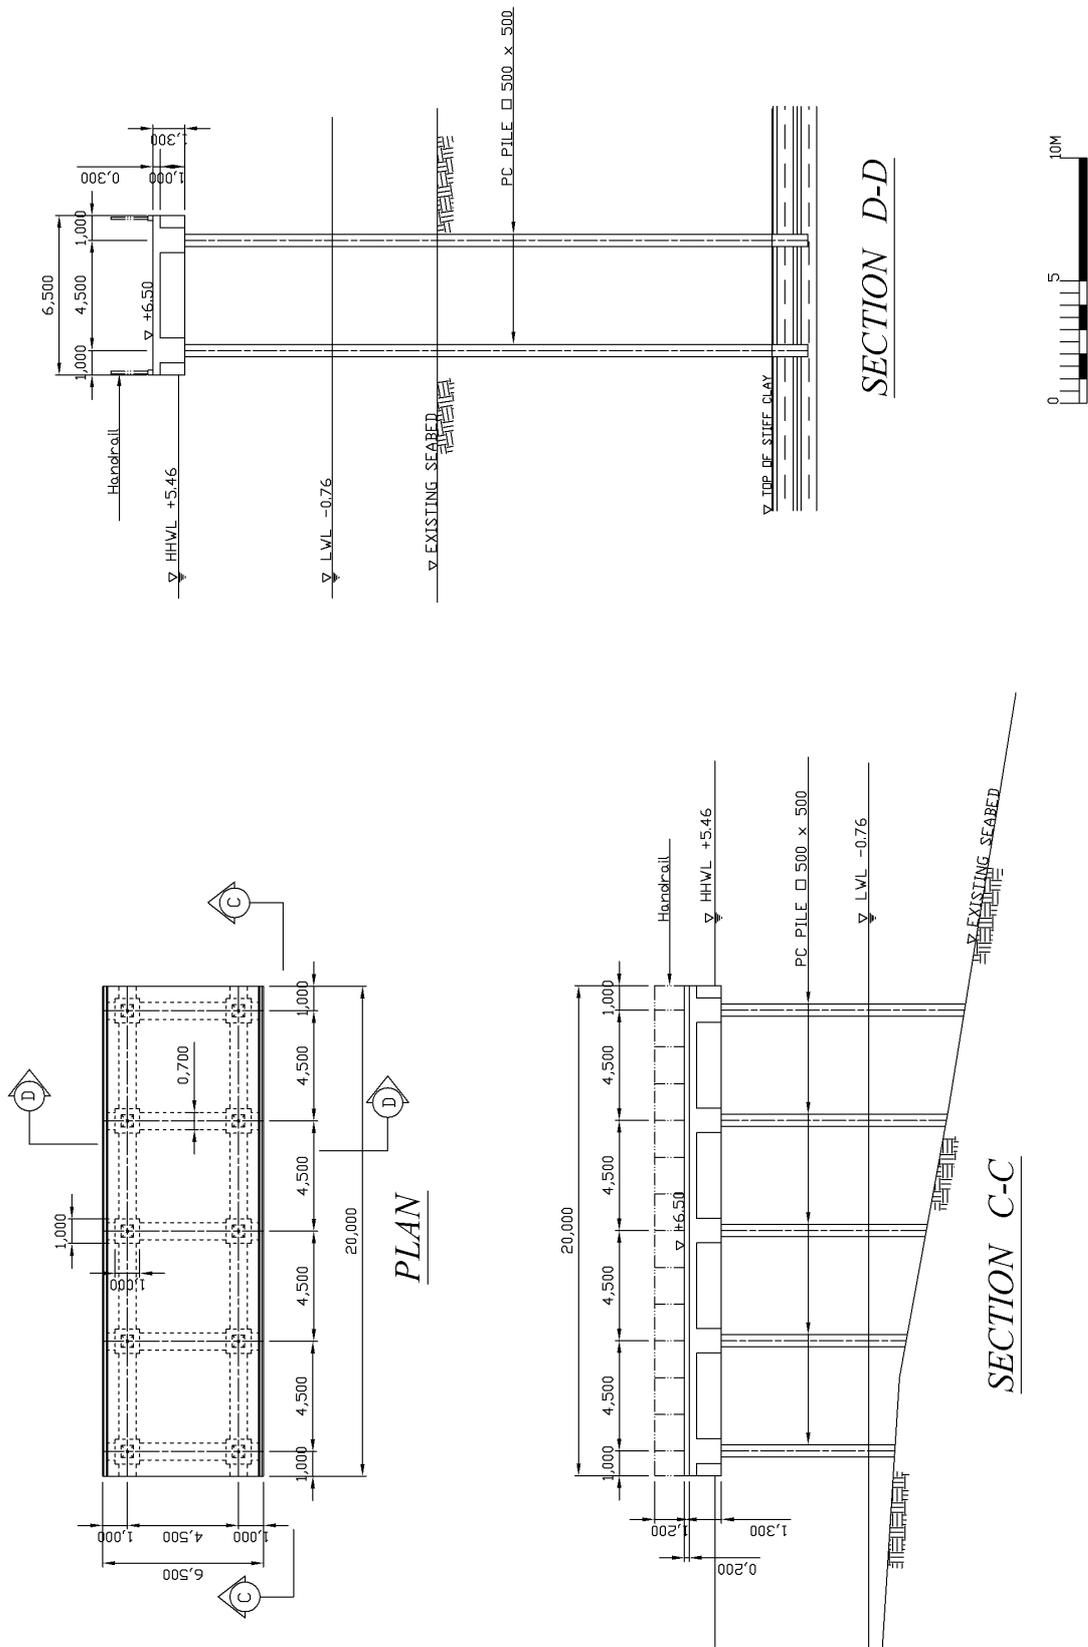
Diseño Estructural de Puesto Acceso
